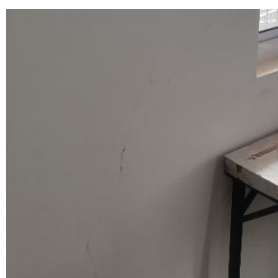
Fissura em parede da área comum em Foz do Iguaçu.
